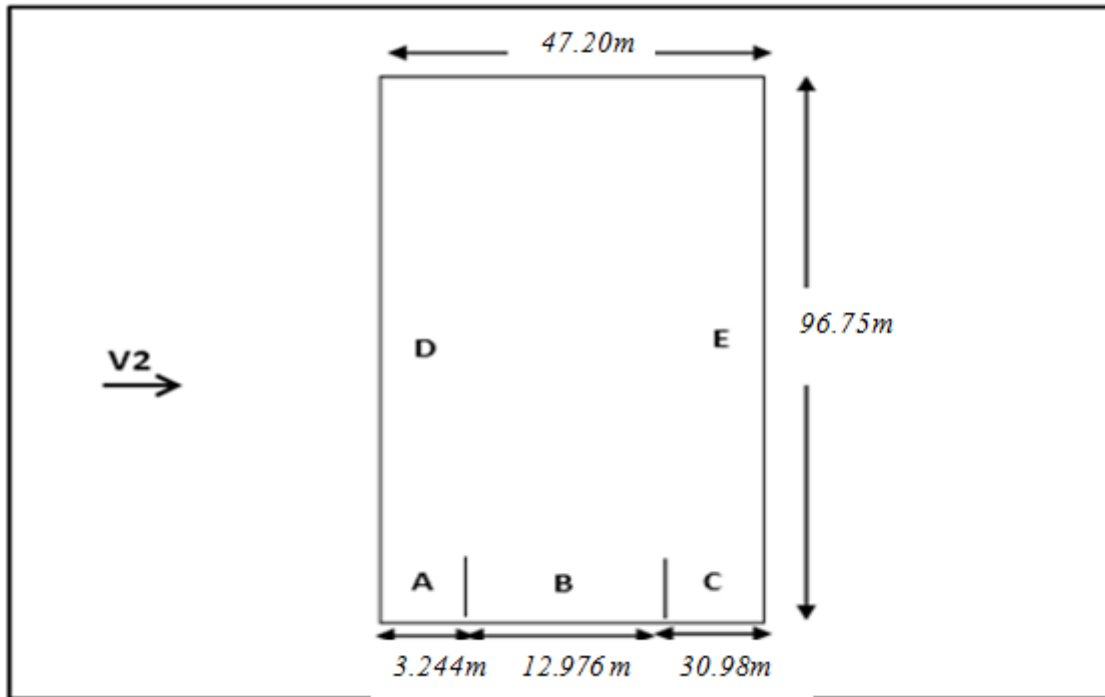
Vue en plan des zones de pression sur les parois verticales sens V₂.
